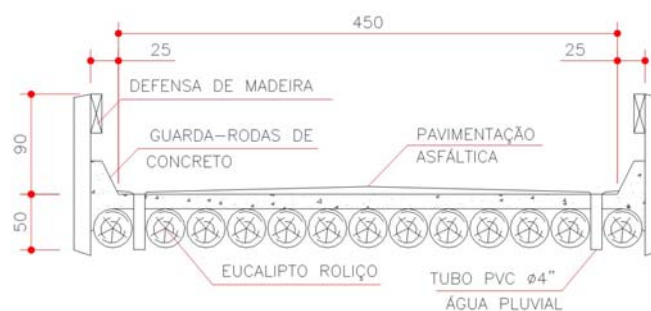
Seção transversal da ponte em placa mista de madeira-concreto com uma faixa de tráfego. Fonte: CALIL et al (2006).
